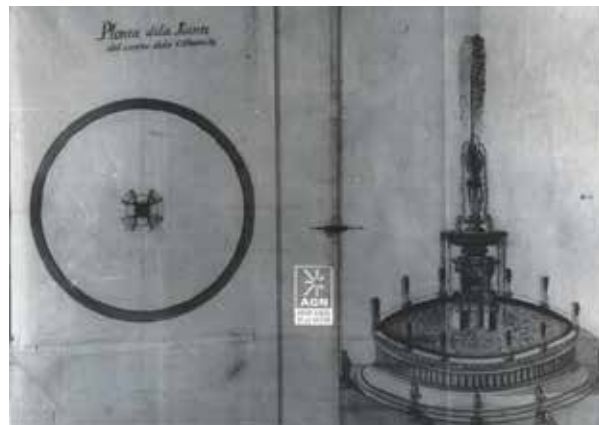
Fuente Central de la Alameda de Querétaro, Querétaro. Plano, planta y alzado. Escala 10 varas, 41 x 52cm. Obras Públicas vol.37, fc.106. Autor: José Mariano Oriñuela, Arquitecto. Archivo General de la Nación, 1798.
